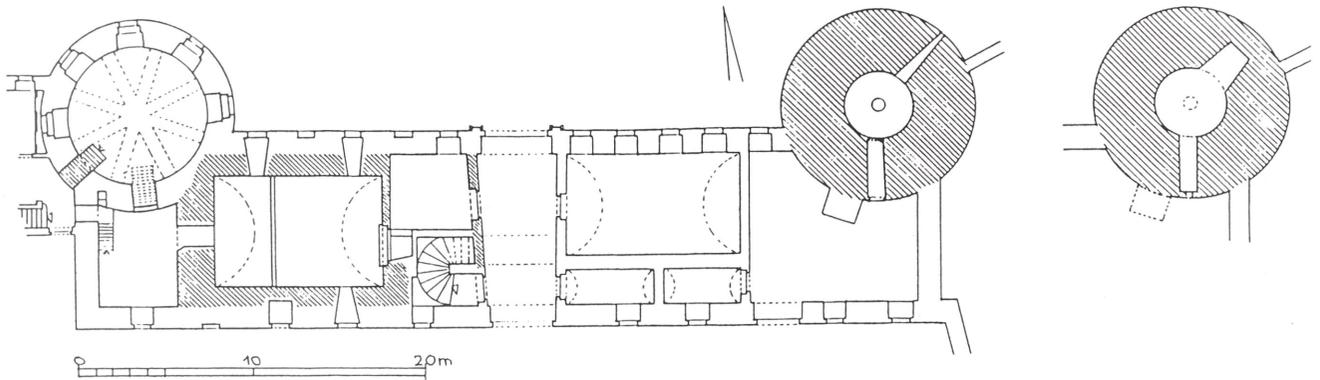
Schloß Aschhausen, Grundriß Erdgeschoß (schraffiert = mittelalterliche Bauteile) (Zeichnung: Verf.).
